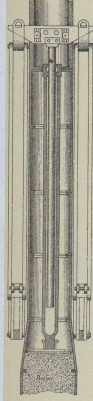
Hydraulische Schleuse bei „La Louvière“. Grundriss.
